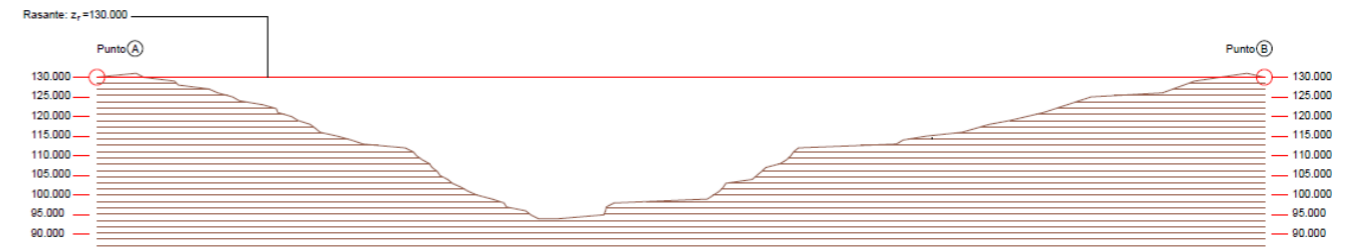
Perfil desarrollado del terreno, donde se ubicará la pasarela. Fuente: Elaboración Propia (AutoCAD)
